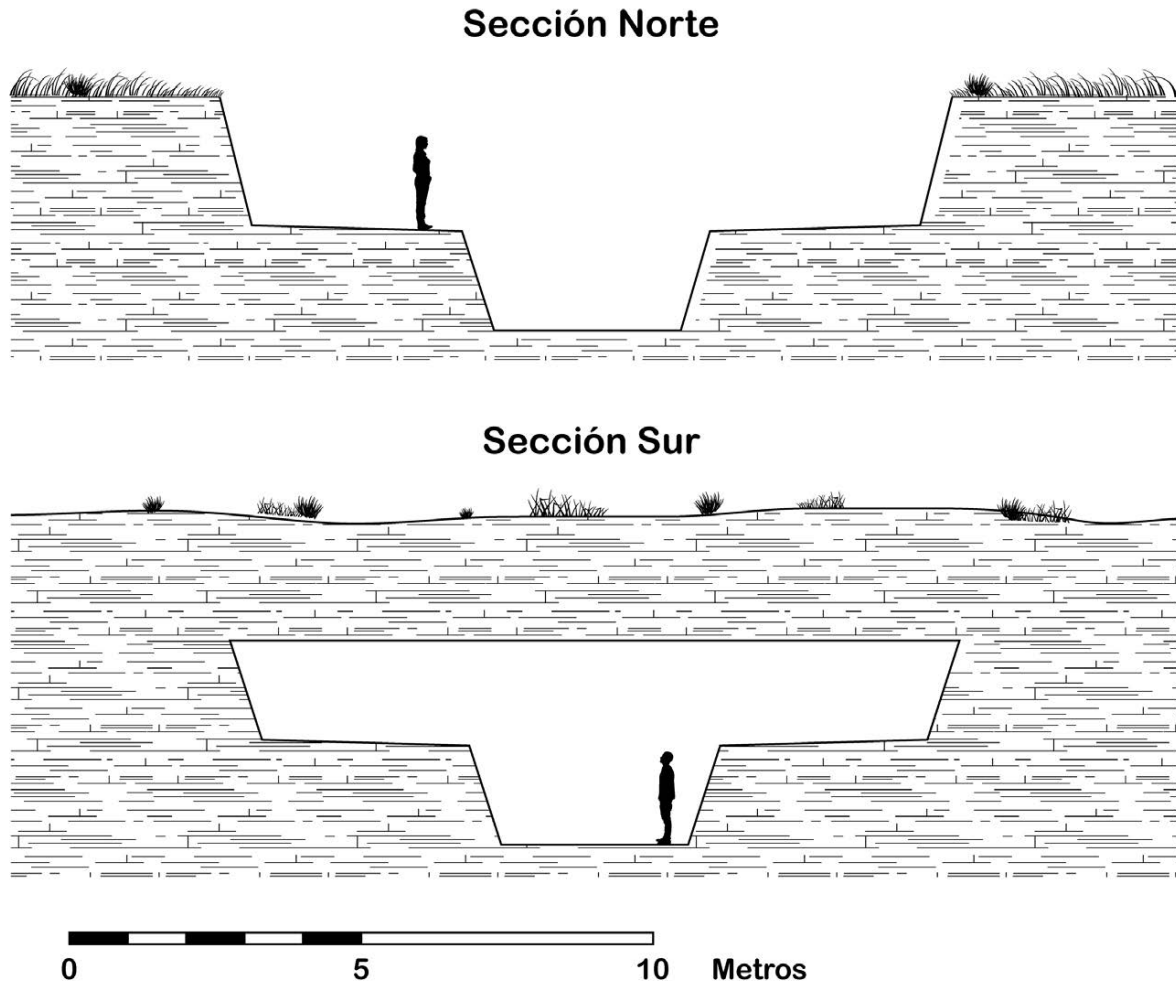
Reconstrucción hipotética de secciones transversales de Secciones Norte y Sur, Canal Norte (Dibujo: C.R. Chiriboga, PAET).
